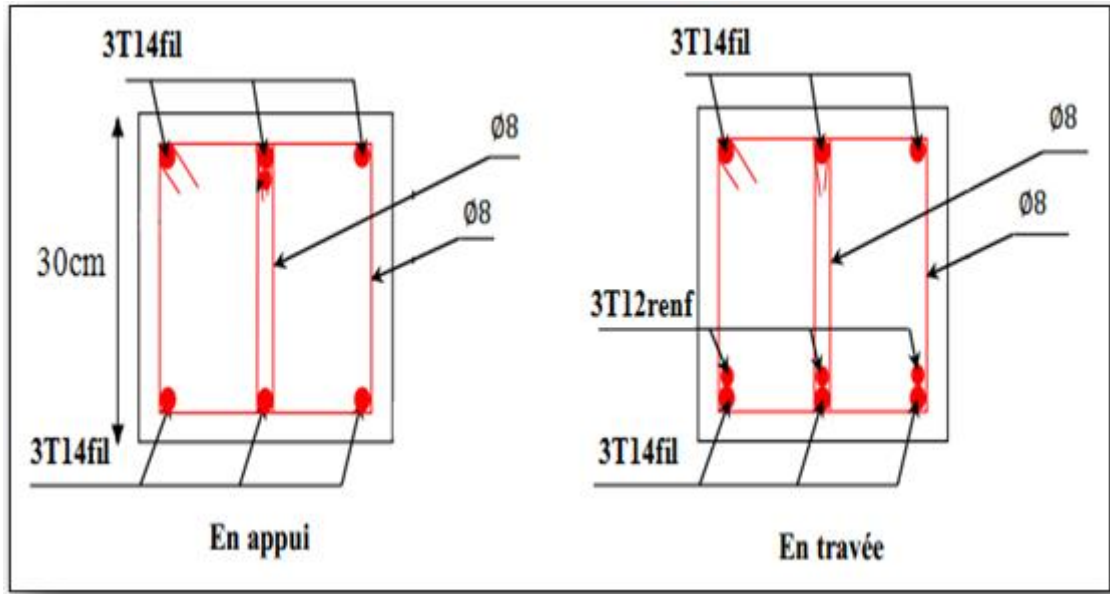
Schéma de ferrailage de la poutre palière.
